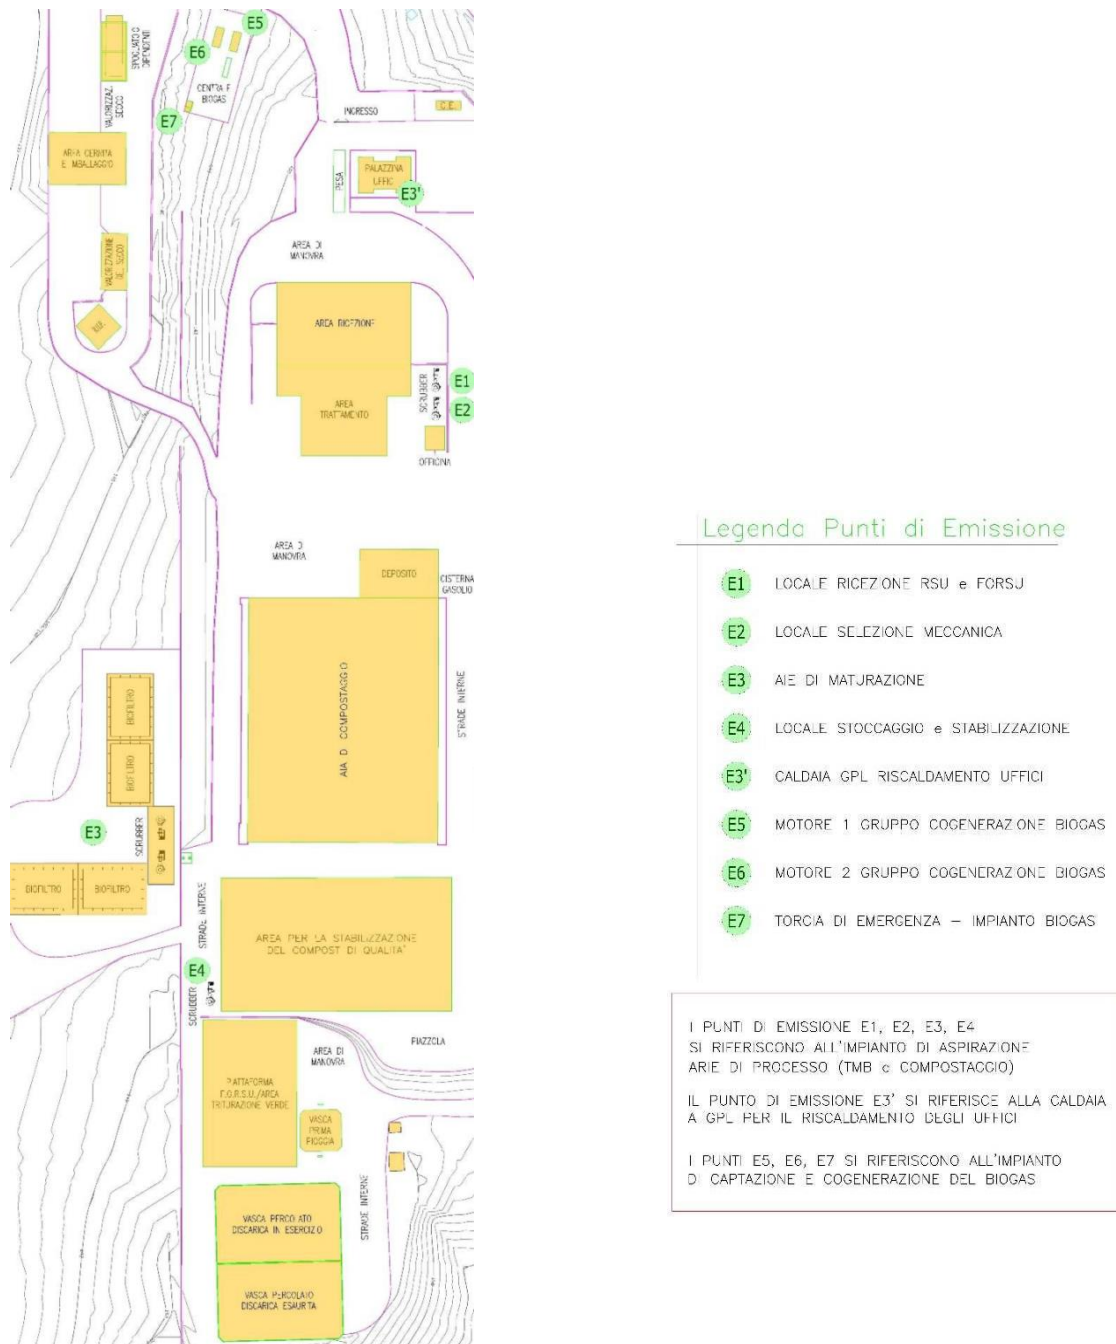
Planimetria dell'impianto complesso esistente C.I.V.E.T.A con indicazione delle sorgenti emmissive
